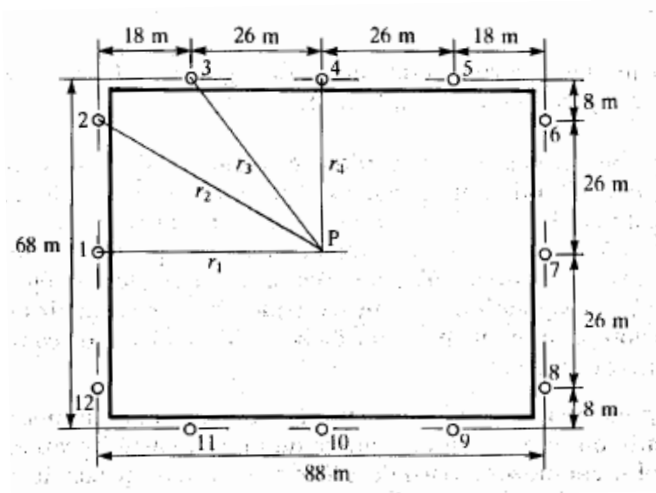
Planta de la excavación sobre acuífero confinado (Abatimiento con pozo múltiple)
